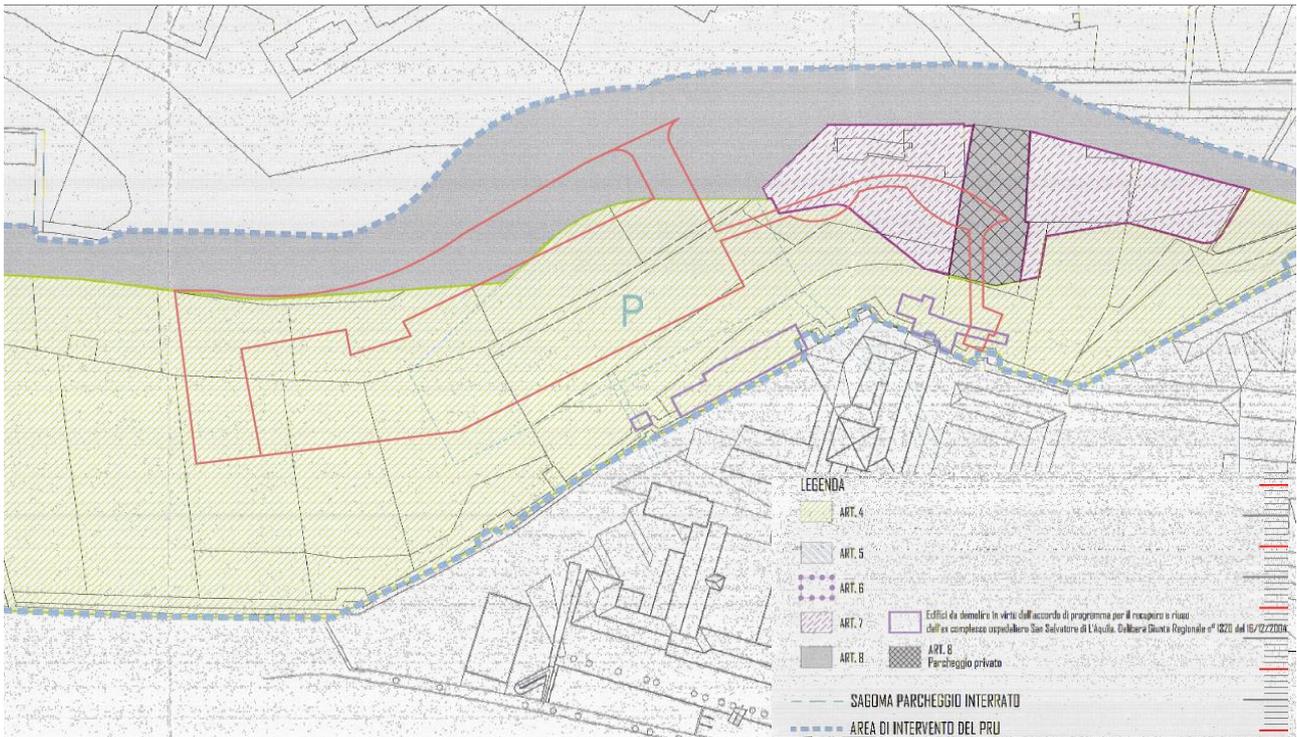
SOVRAPPOSIZIONE DELLA SAGOMA DI PROGETTO CON LA ZONIZZAZIONE DEL PRU PRU APPROVATO CON D.C.C. 108/2016
